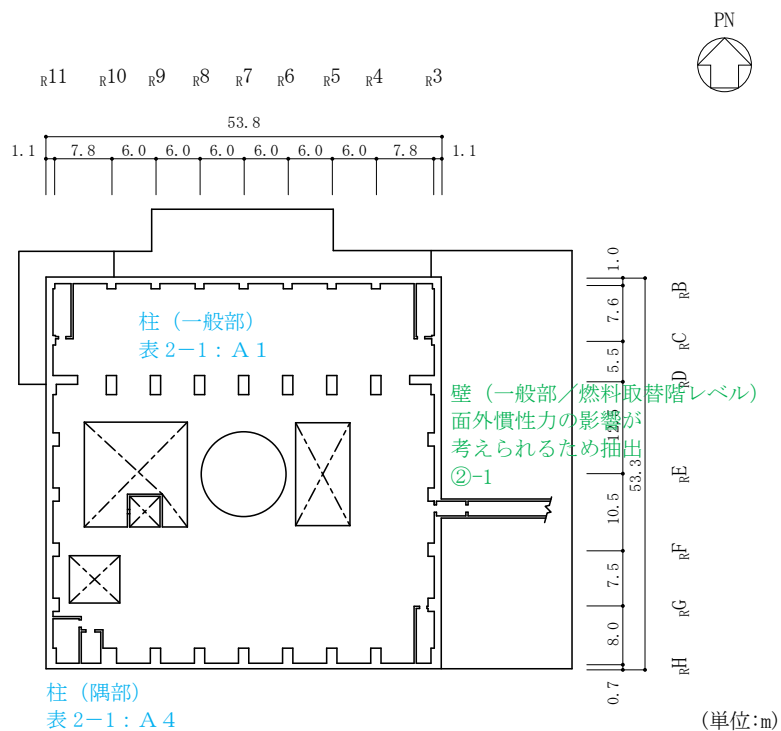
(7) 原子炉建物の概略平面図 (EL 42.8m)
